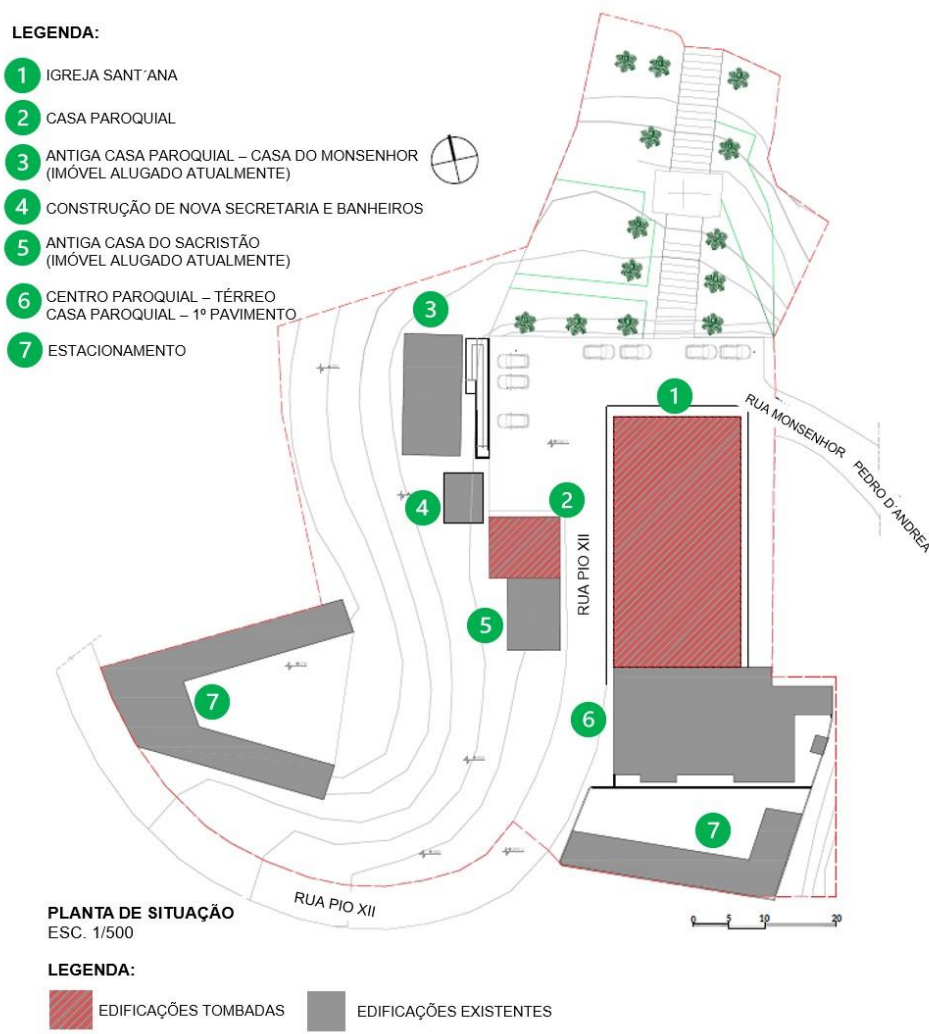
Planta de situação do entorno imediato existente com ênfase as edificações tombadas.
